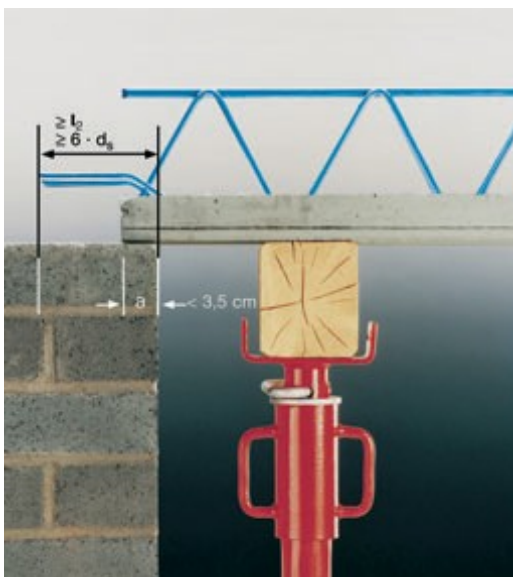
appui avec étaieiment (étaieiment de rive)
